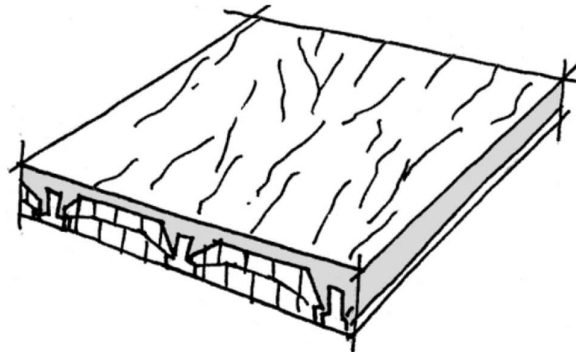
Fisuras paralelas en la cara superior de la losa (Fuente, MPE)
